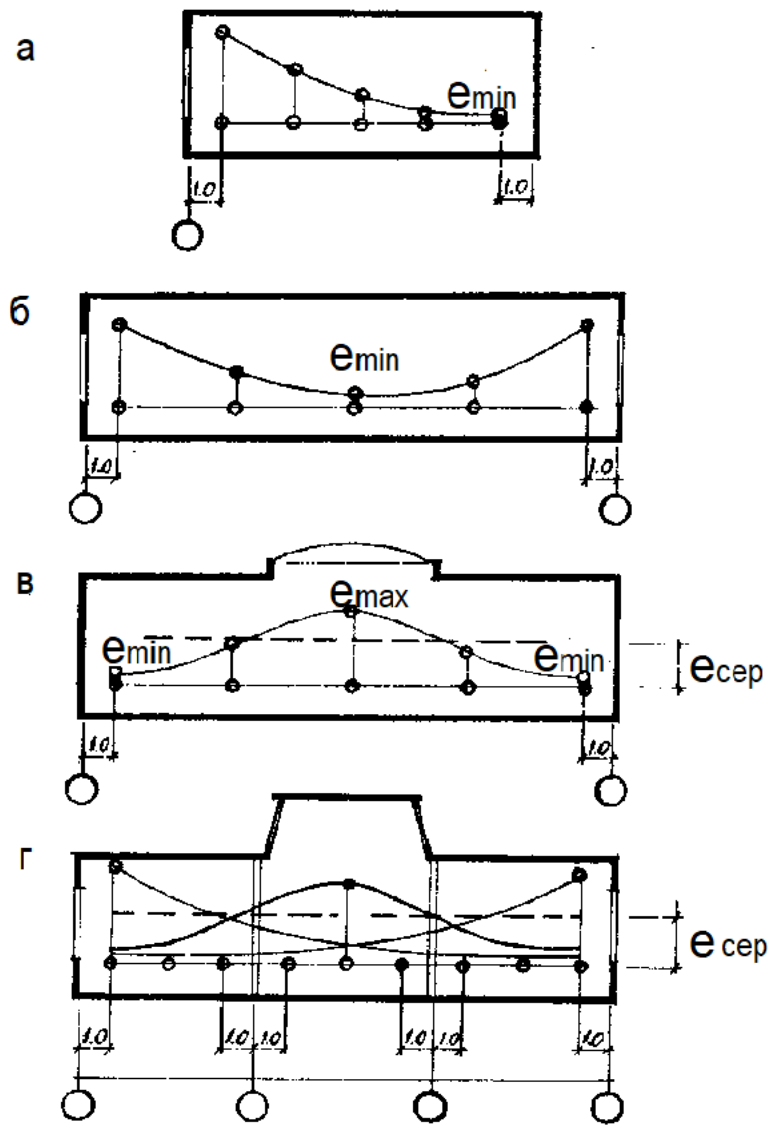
Розрахункові точки на робочій поверхні
